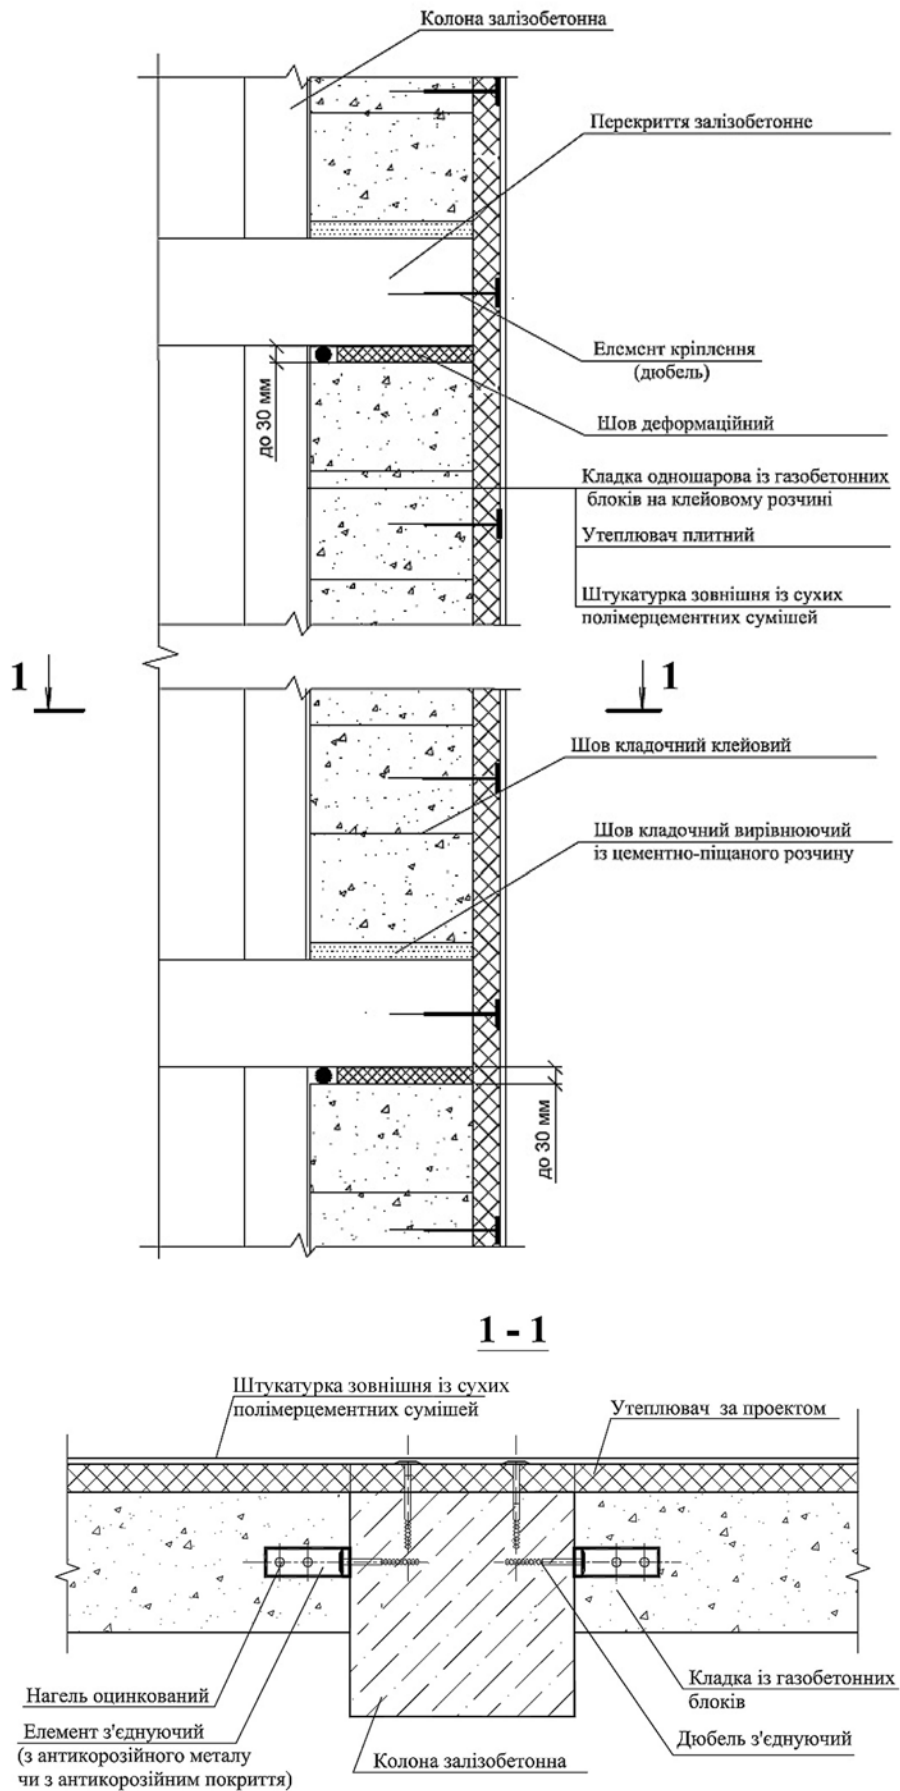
Стіна зовнішня багатшарова із газобетонних блоків та плитним утеплювачем і обштукатуренням
